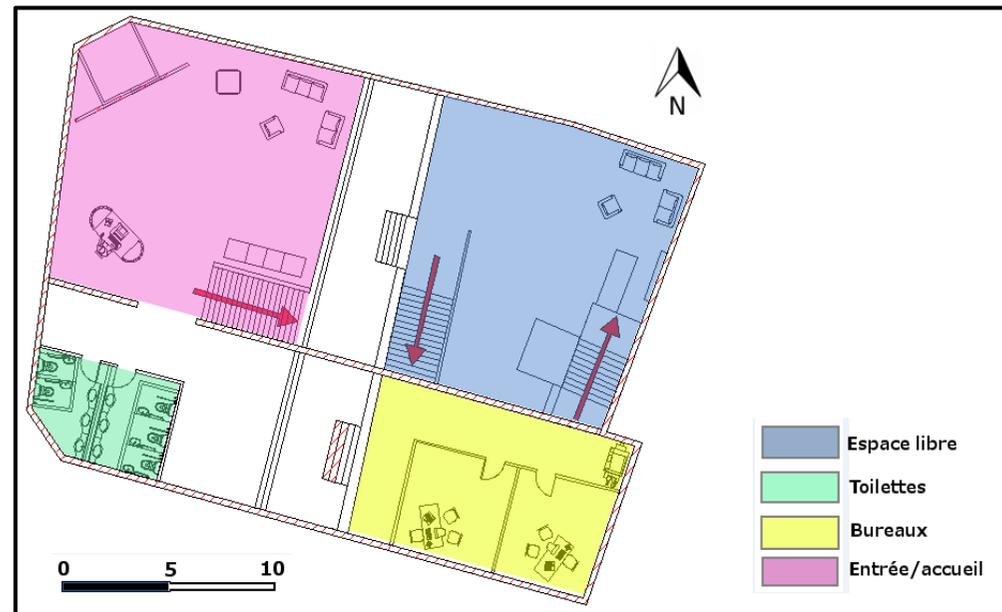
PLAN DE MASSE DU REZ-DE-CHAUSSEE DE LA MAISON DE LA JEUNESSE
